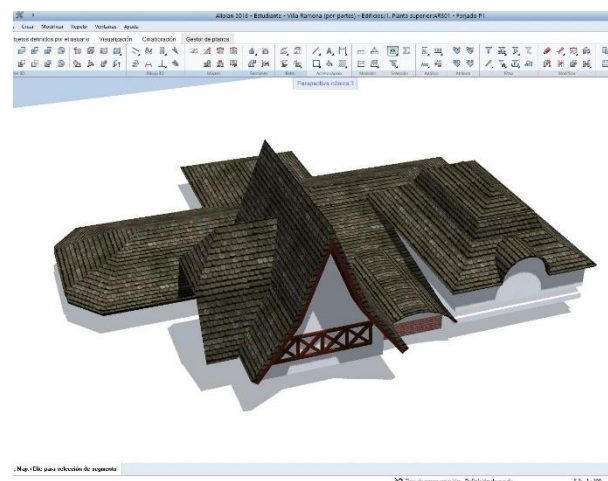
Maqueta de cubierta. Fuente: Elaboración propia
